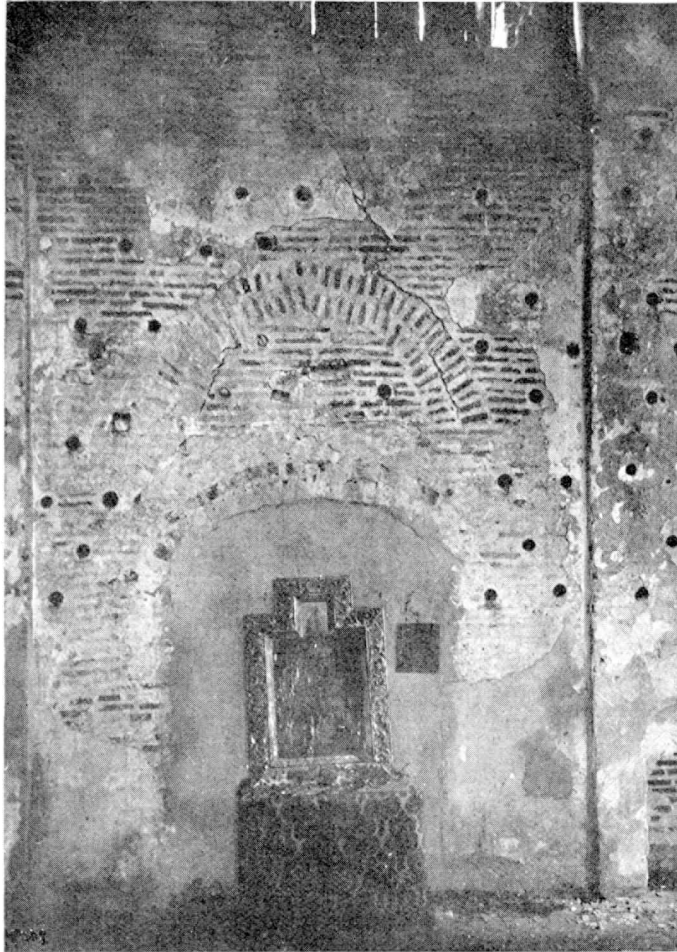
Fragment wnętrza cerkwi przy zachodniej elewacji.
